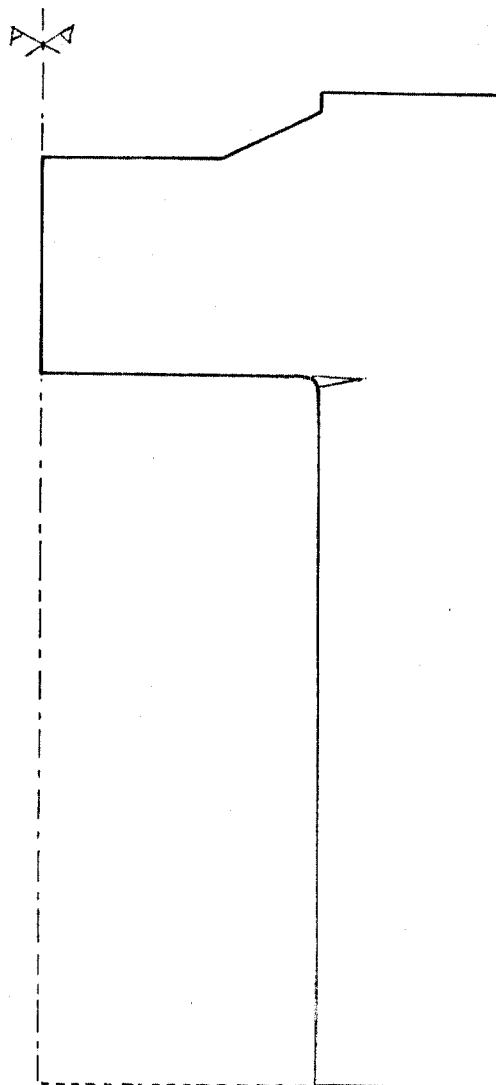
Esquema de Fissuração Prevista pelo Cálculo à Pressão Interna de 154 kg/cm^2
